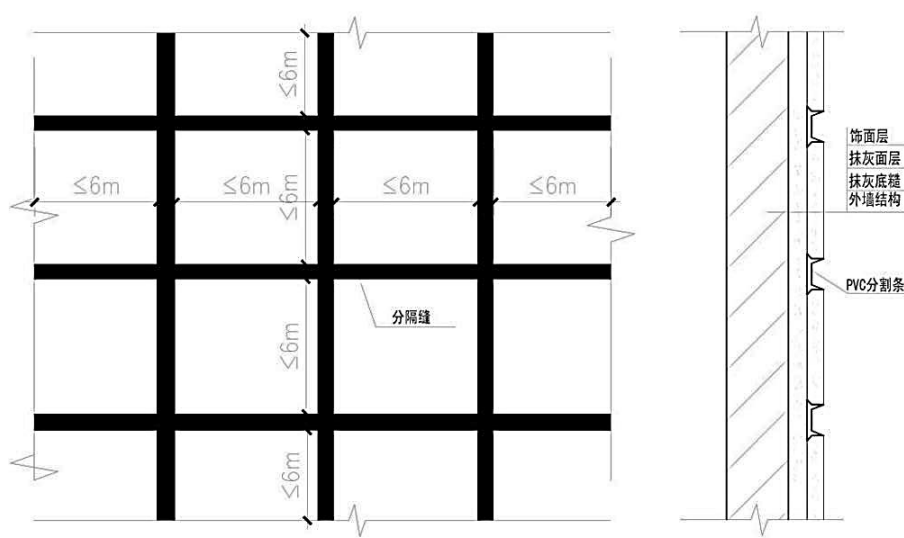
外墙抹灰分隔条排版示意及剖面图
